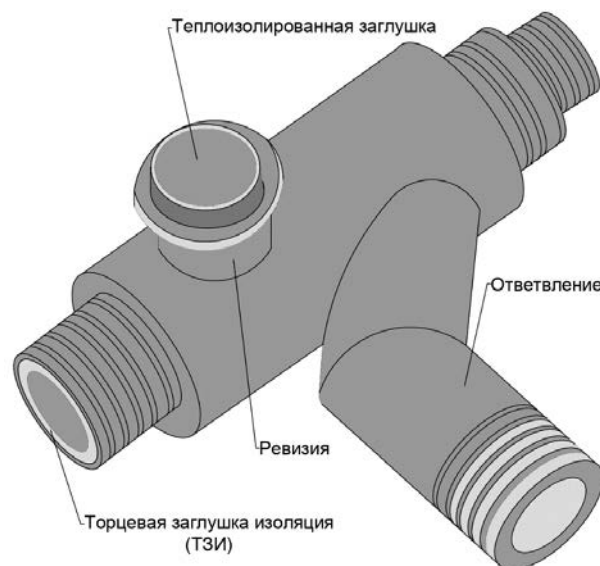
а Конструкция тройникового присоединения 45° с ревизией 90°.
